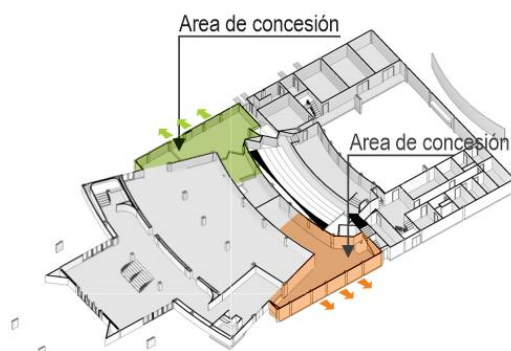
Planta de primer piso- sótano, áreas de concesión
